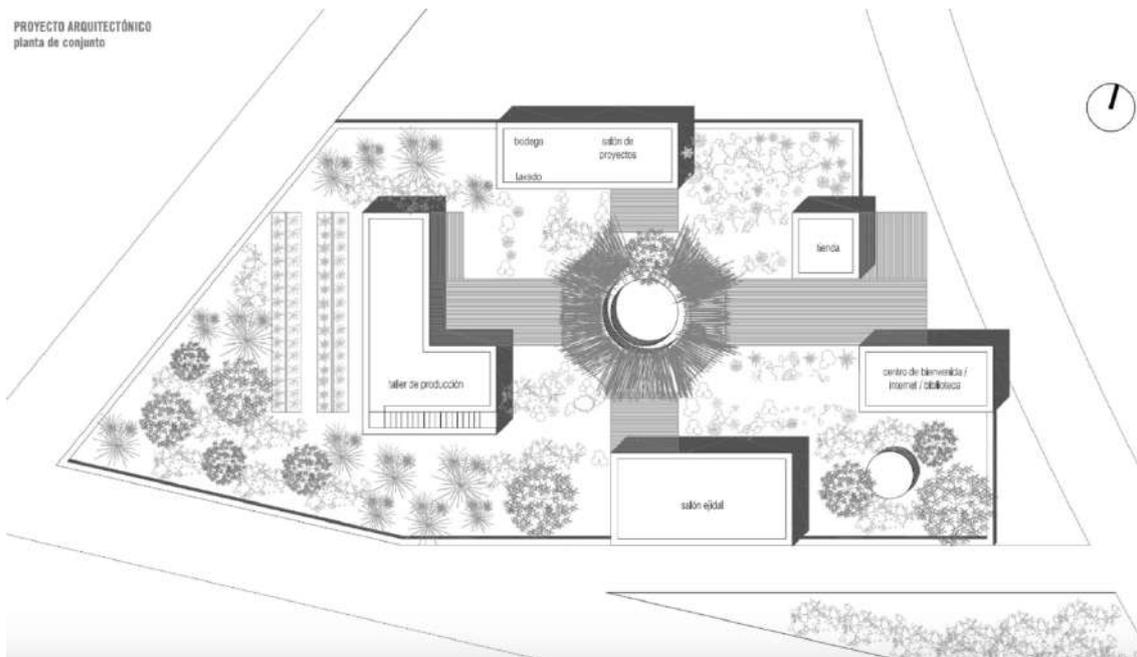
Planta de cobertura (Dellekamp, 2020)
